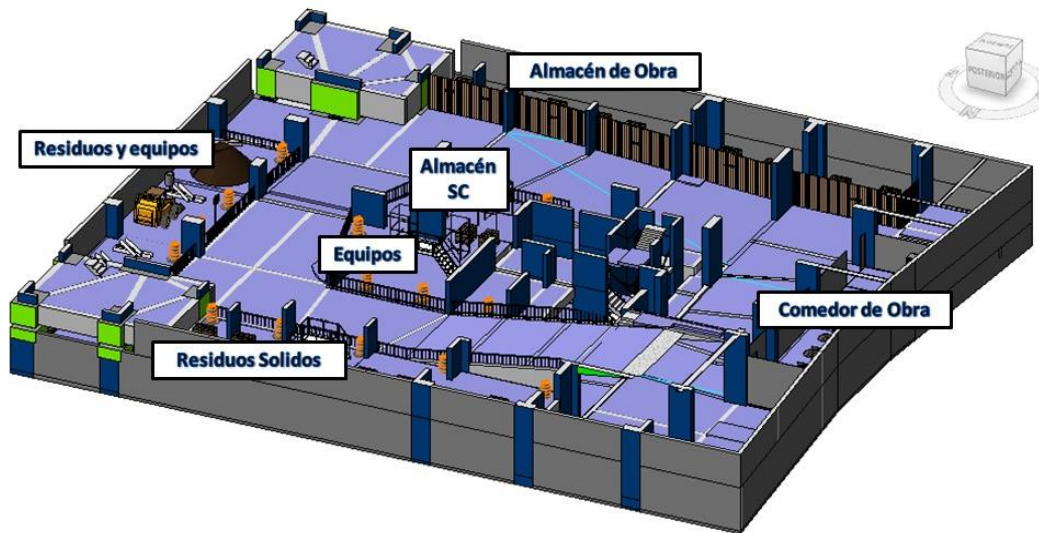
Representación de obras provisionales y distribución de elementos en planta del sótano 1. Fuente: Propia.
